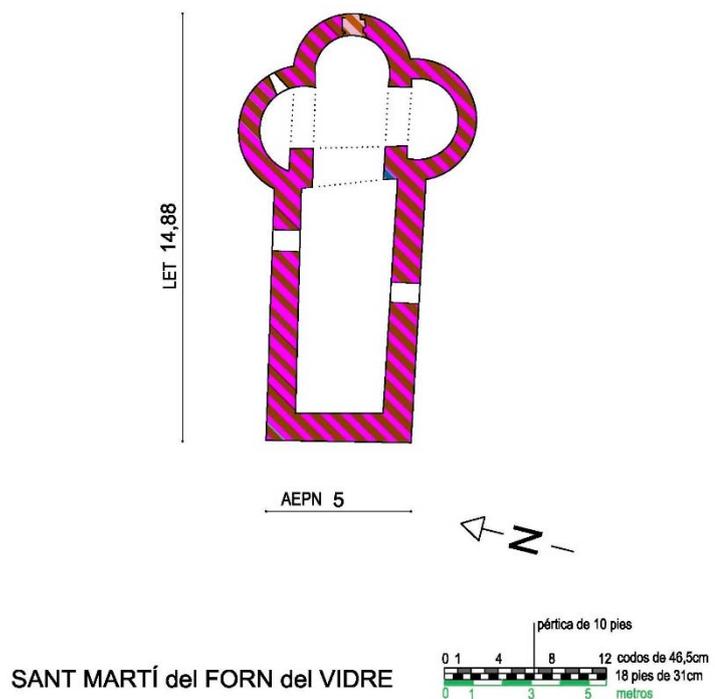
Planta crono-cromática de St. Martí. Elaborada por autora.
